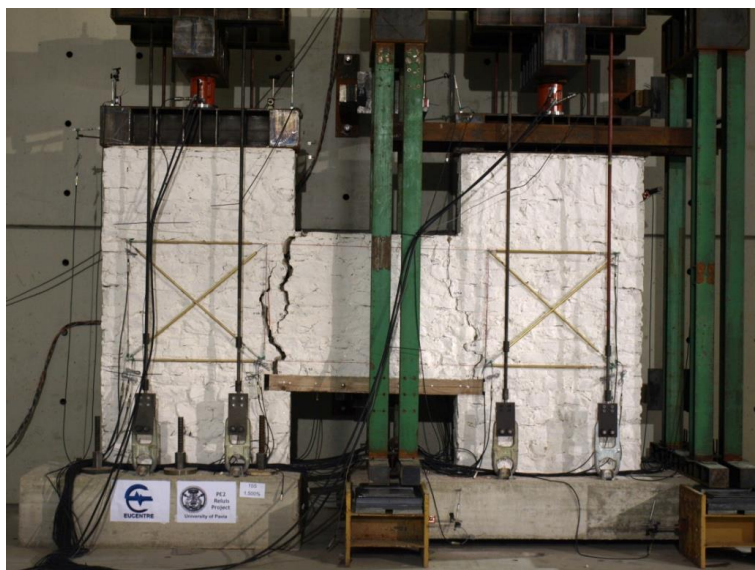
fissure du premier corps d'essai (spécimen 1) des linteaux en pierres naturelles avec poutre en bois testés à l'EUCENTRE.
